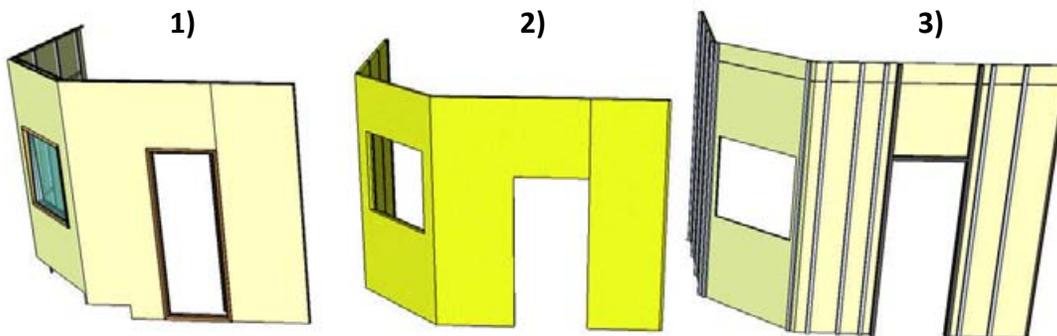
Componentes de la pared doble. 1) Pared exterior, compuesta por estructura metálica y doble placa de yeso cartón de 12.5 mm. 2) Material absorbente instalado en la cavidad formada por las dos paredes. 3) Pared interior compuesta por estructura metálica y doble placa de yeso cartón de 12.5 mm.
